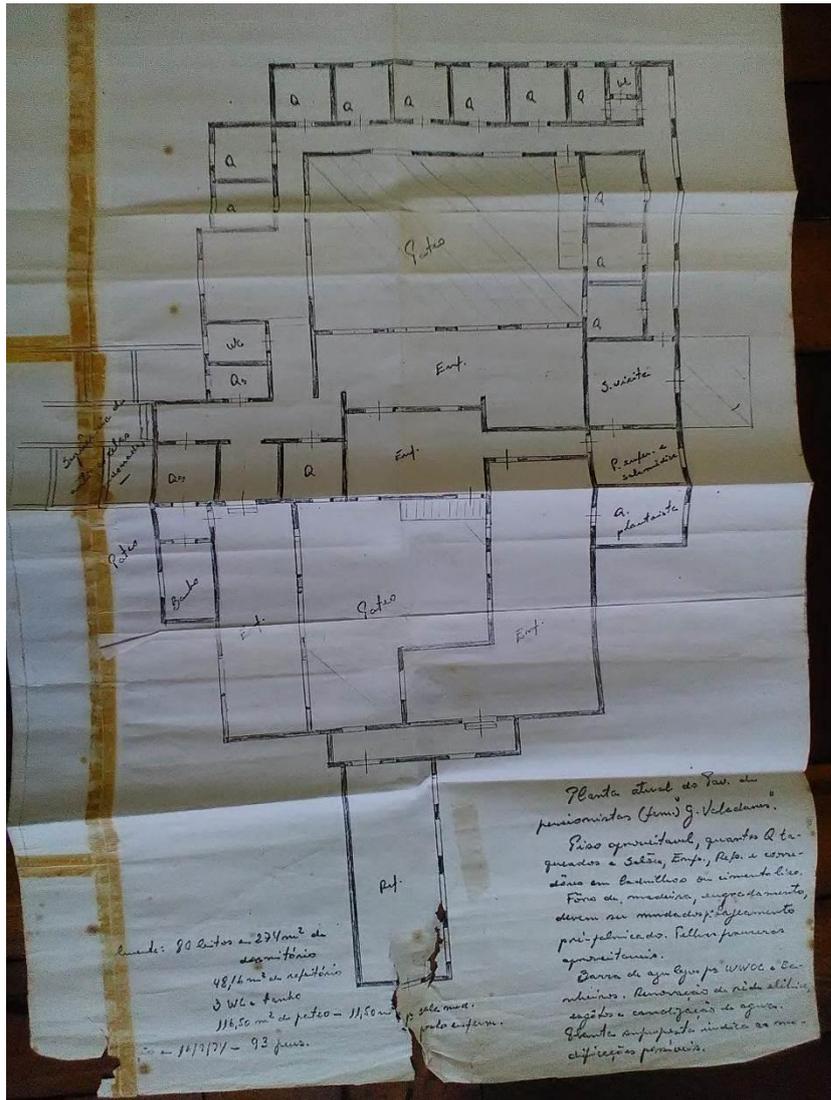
Abertura do Capítulo 4: Planta baixa do pavilhão Governador Valadares
